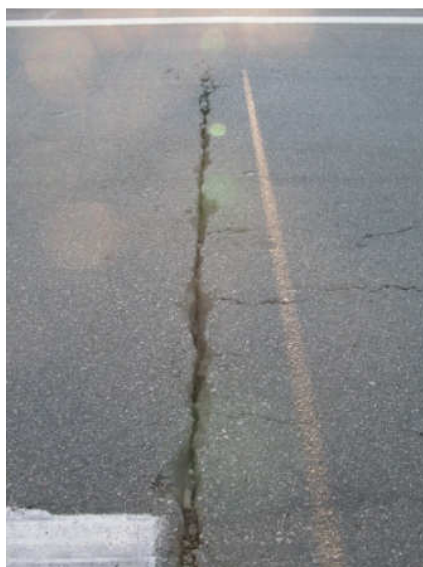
Fissuração do pavimento na pista da direita, sentido Belo Horizonte – São Paulo.
